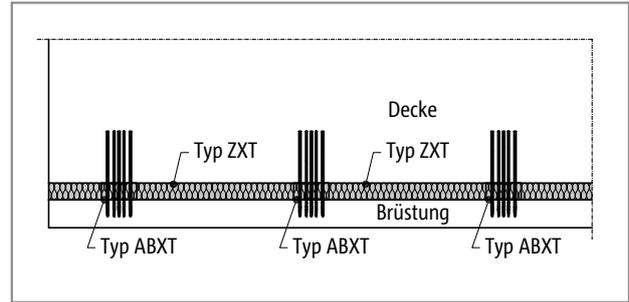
Schöck Isokorb® Typ ABXT horizontale Anordnung: Grundriss Brüstung vorgesetzt
